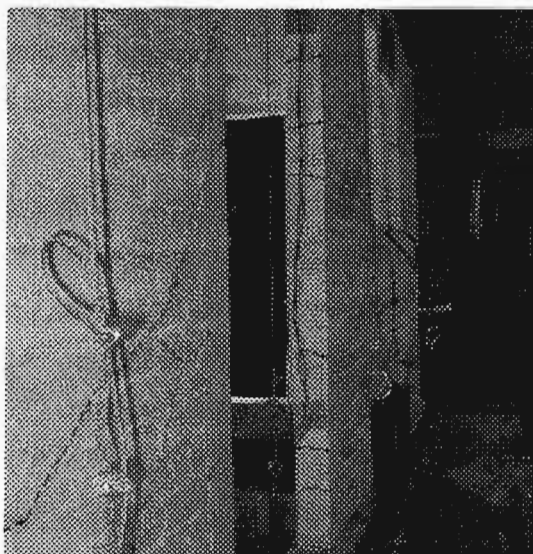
Agrietamiento en los castillos CS4 y CS5 de la fachada Sur
